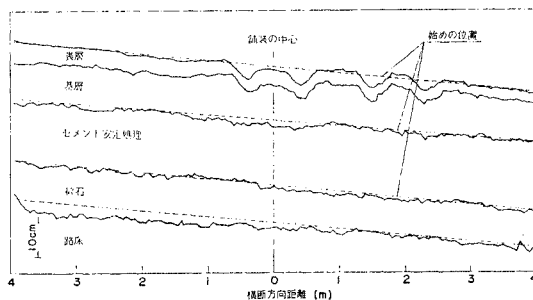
No. 7-1 (SC-5) 舗装の解体断面図
